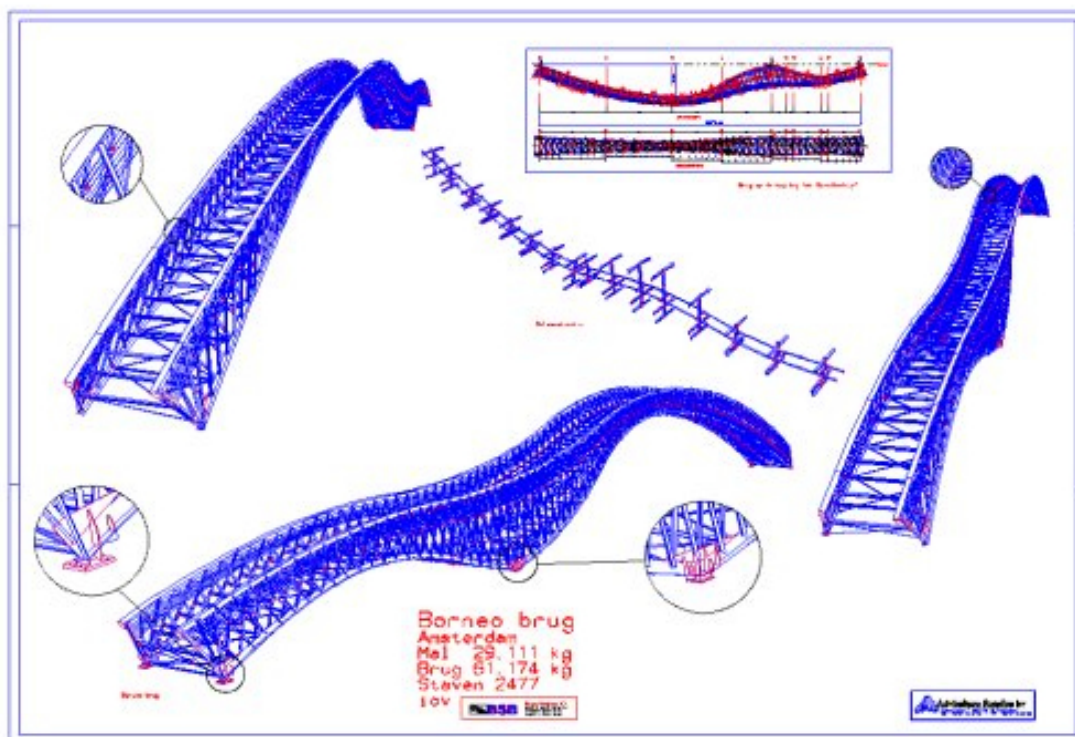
Чертеж металлоконструкции, занявший 1-ое место на конкурсе чертежей StruCad в прошлом году
